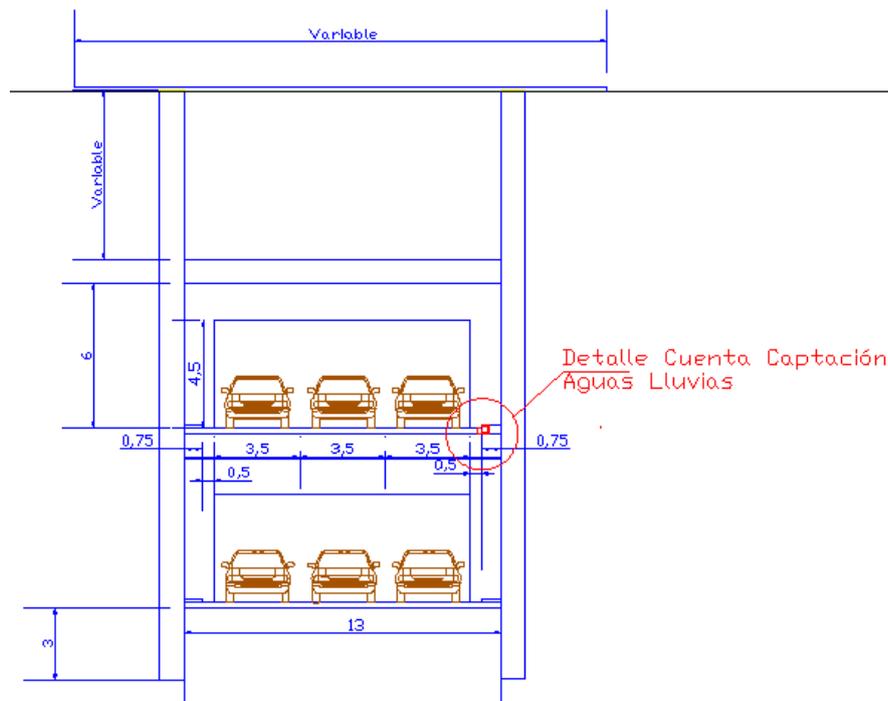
Perfil Tipo Trinchera Cubierta en dos niveles
